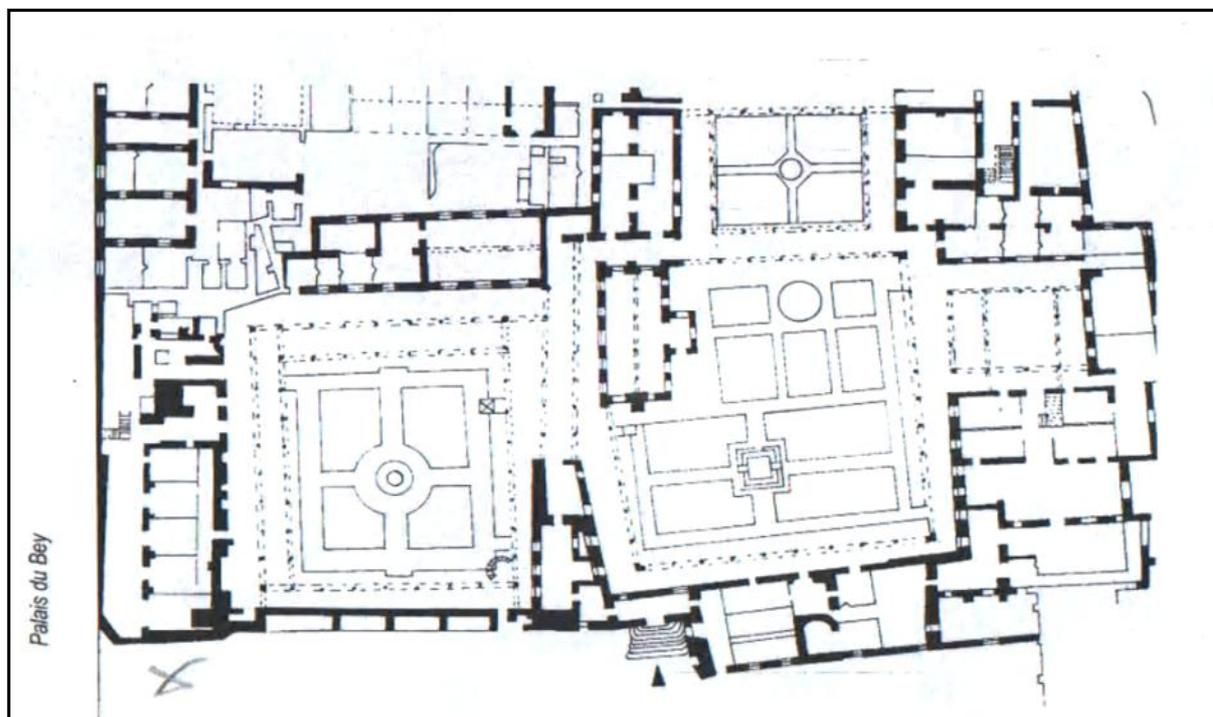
Plan Du Palais Ahmed Bey – Constantine- R.D.C.
